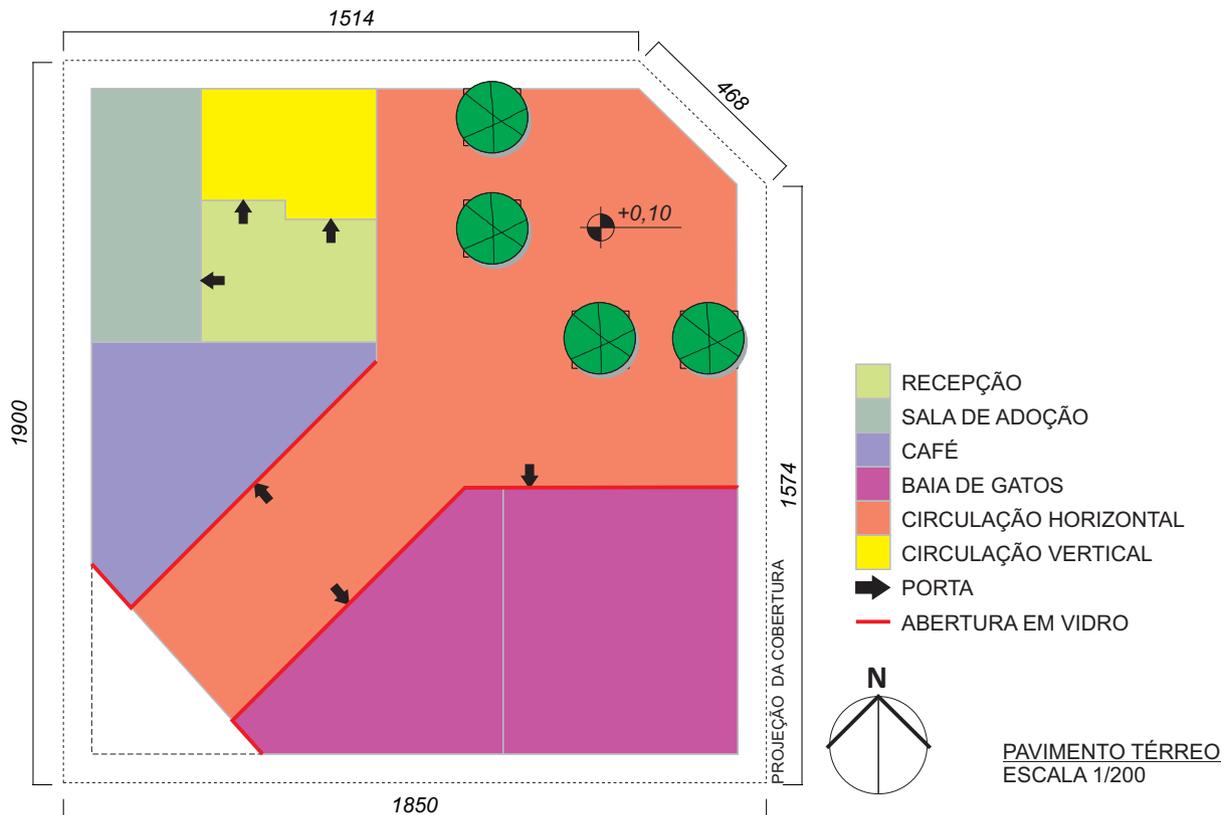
Planta baixa setORIZADA, térreo – Bloco de Adoção. Fonte: Elaborado pela autora.
